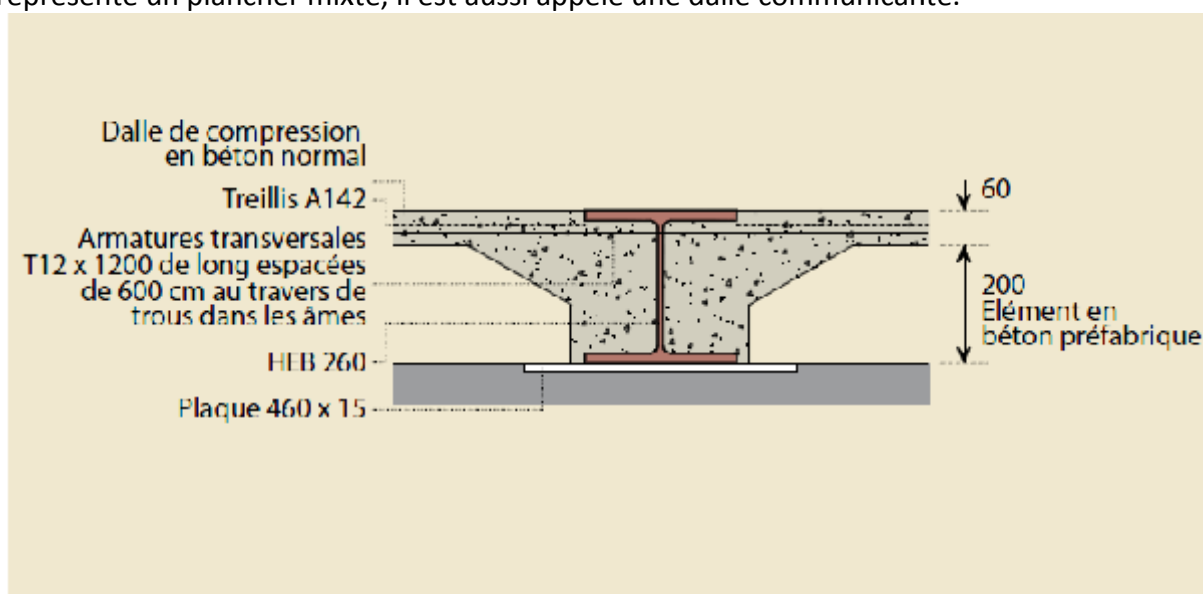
détails du montage dalle mixte a panneaux préfabriqués [9]
